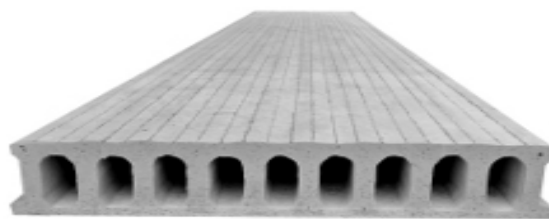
Panel alveolar de hormigón prefabricado [10].
